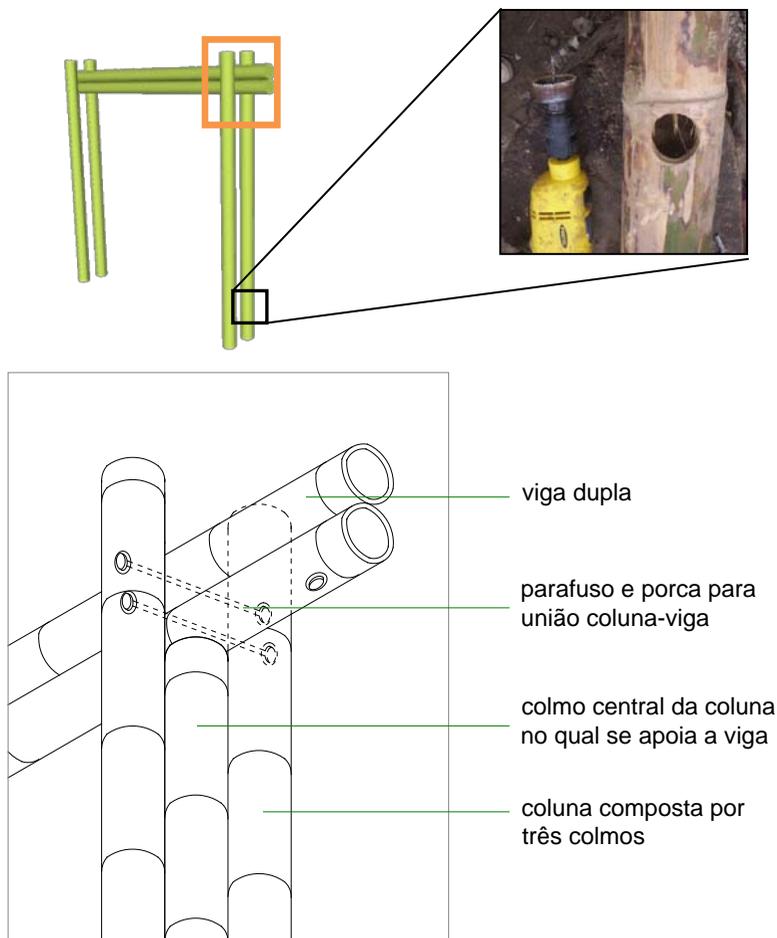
Módulo estrutural de bambu e detalhe da base das colunas
